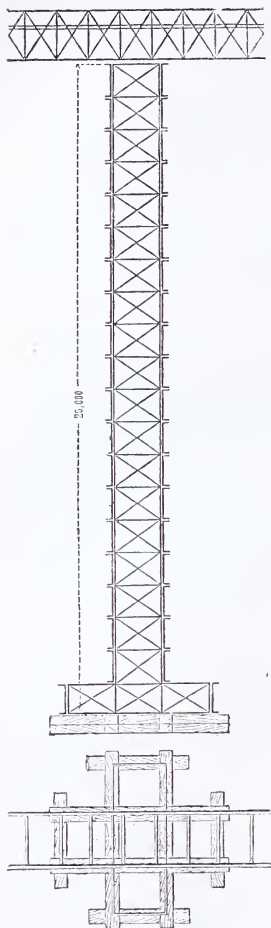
Élévation d'une pile et d'un pont du système Cottrau.
